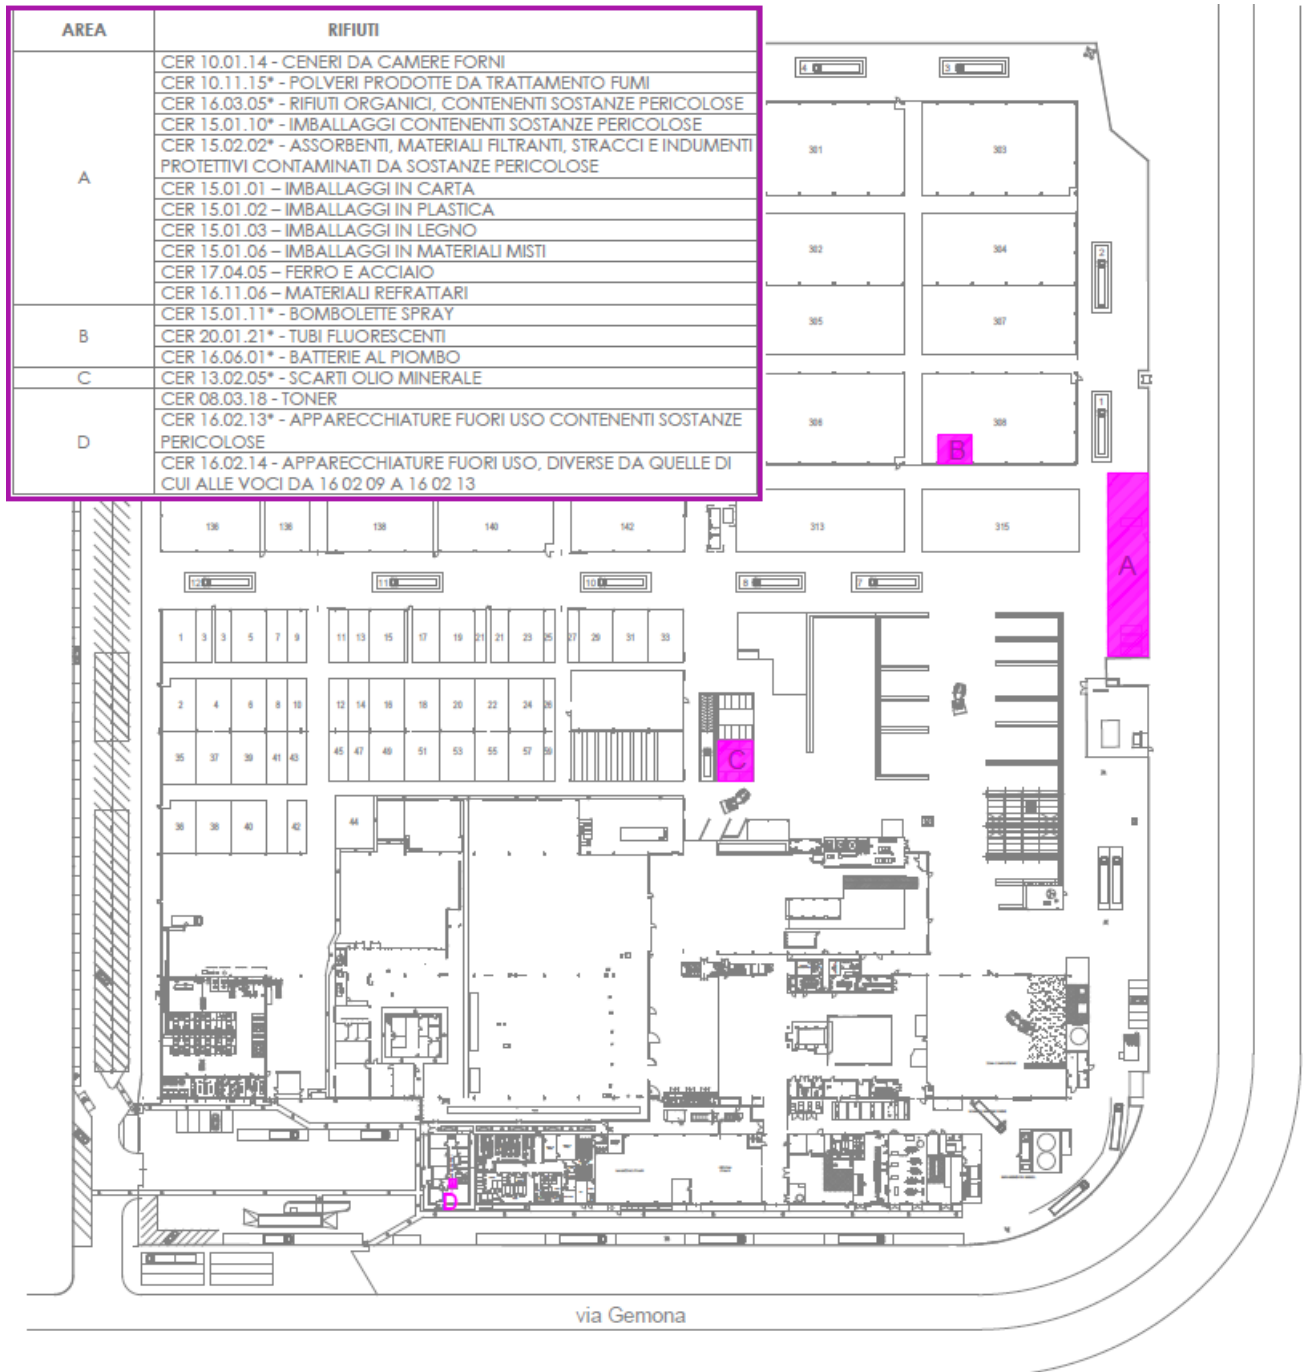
Estratto planimetria AIA di gestione dei rifiuti
